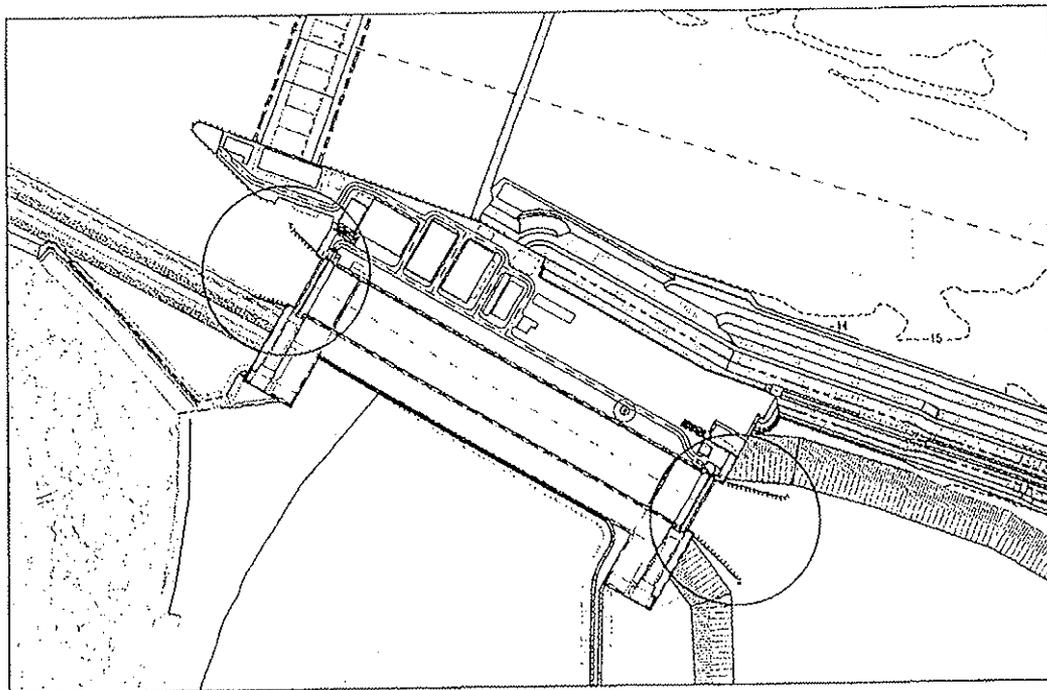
DISPOSIZIONE PLANIMETRICA DELLE STRUTTURE GUIDA
